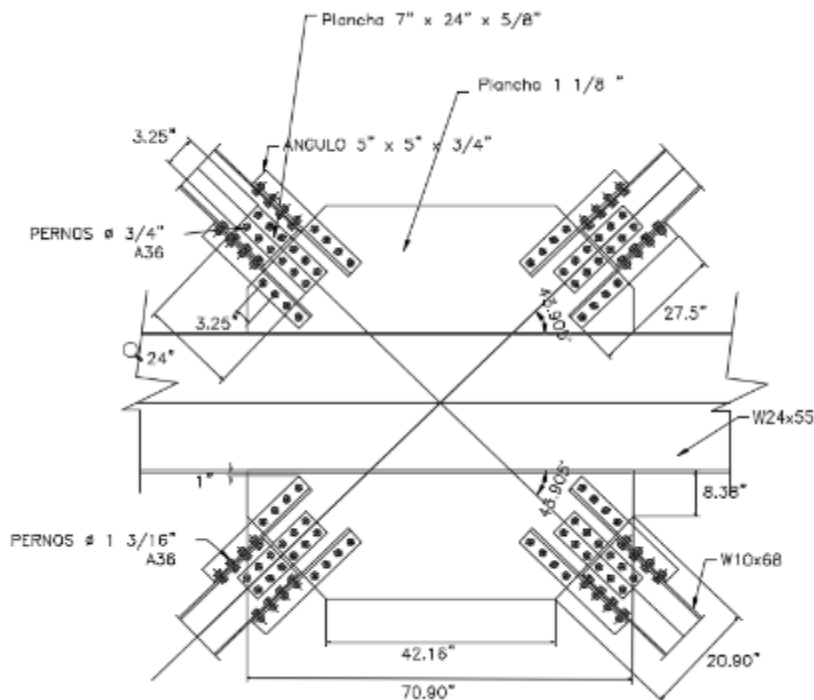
Plancha Nudo en centro de la viga. Fuente: Propia realizado en AUTOCAD.
